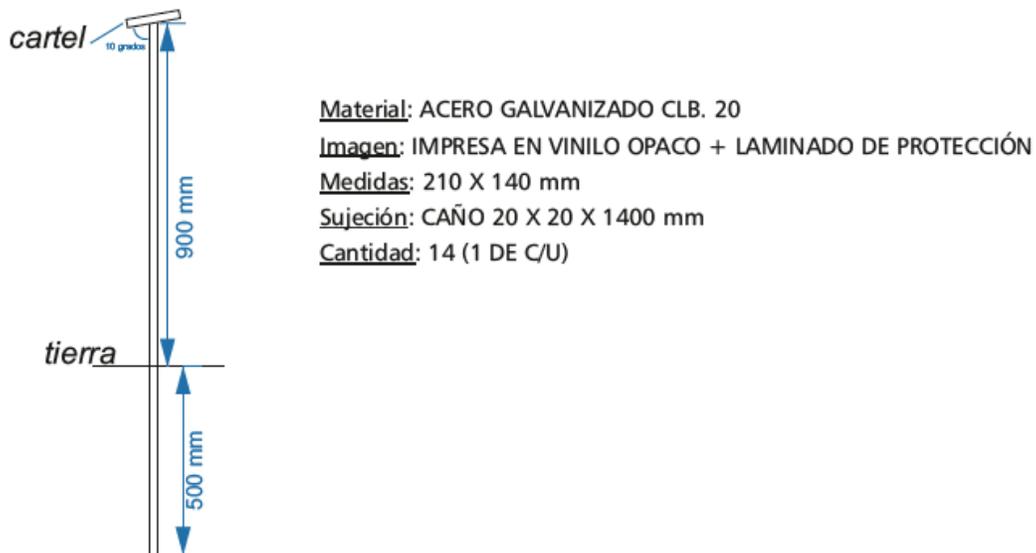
Detalle constructivo de los carteles con las imágenes marcador.
